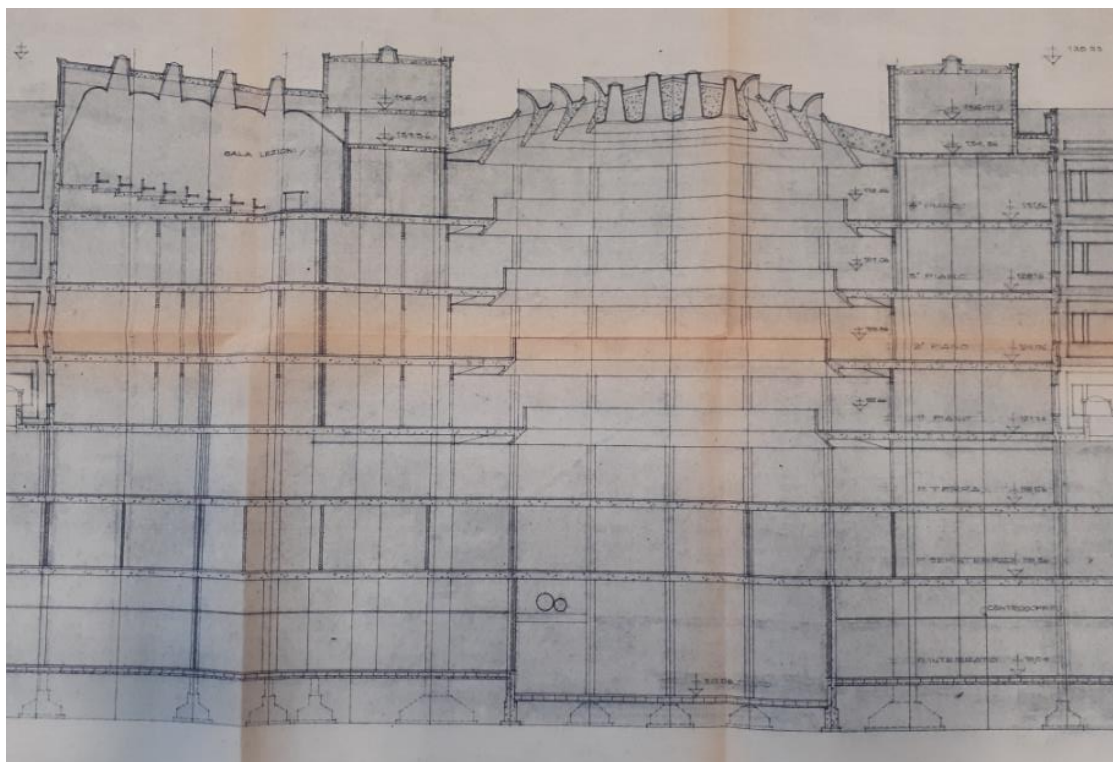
Parte della sezione trasversale - zona atrio - Lotto I
